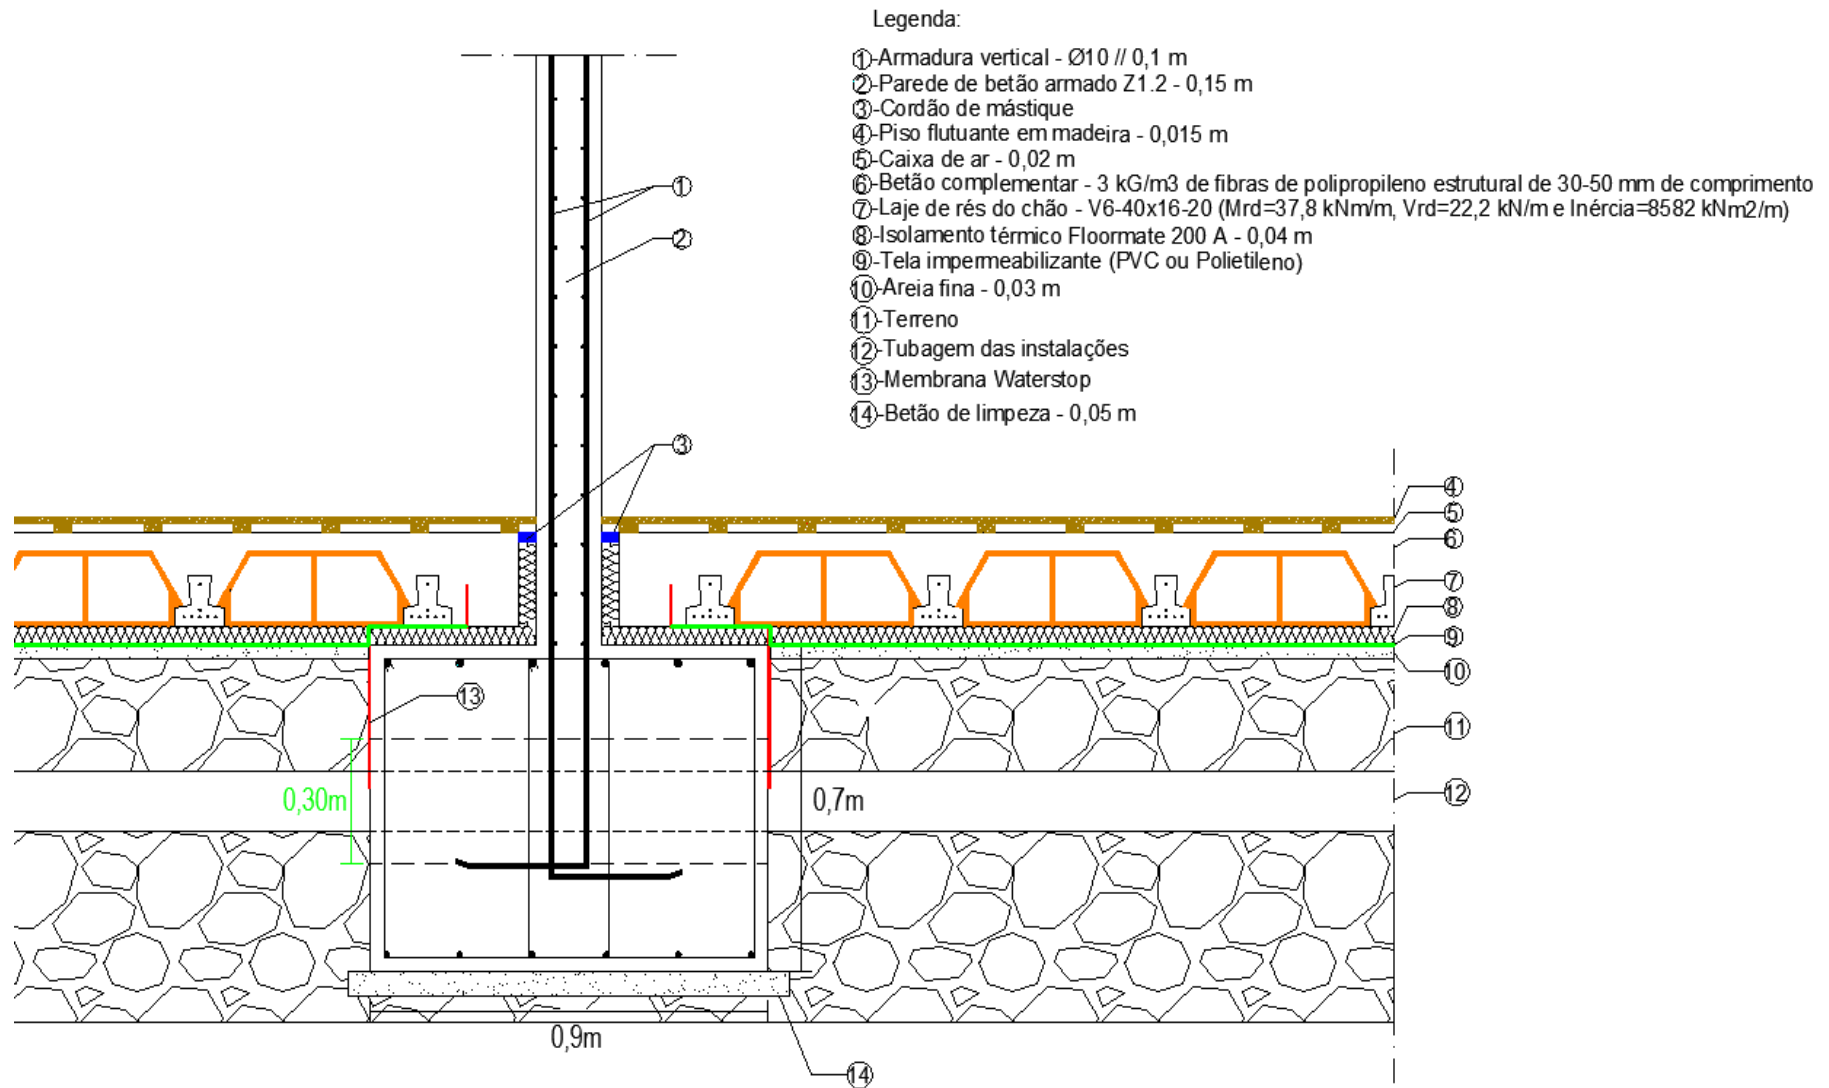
Pormenor da viga de fundação do pórtico 4-4'
